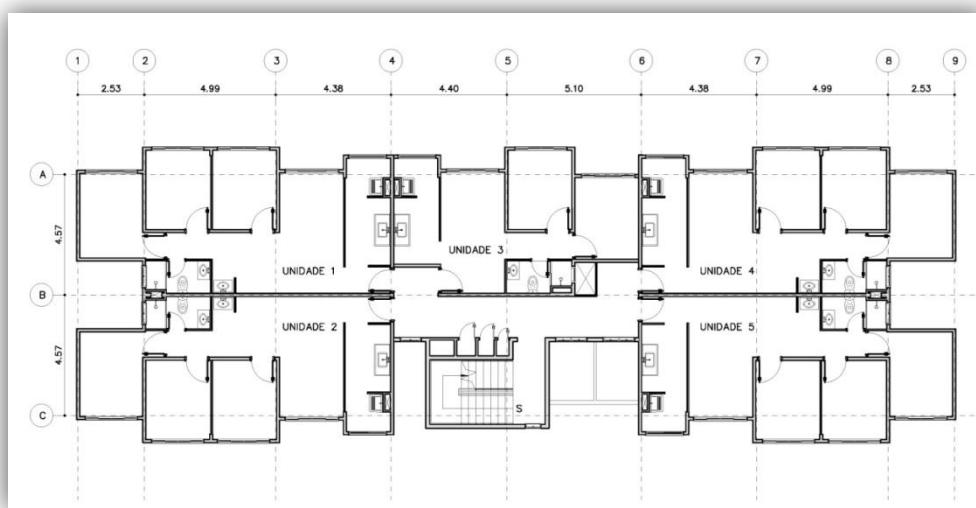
V052-3 – Planta do pavimento tipo; sem escala.
